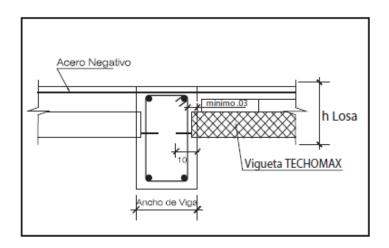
Detalle del anclaje de la vigueta prefabricada tipo Firth en apoyo discontinuo con concentración de acero.
